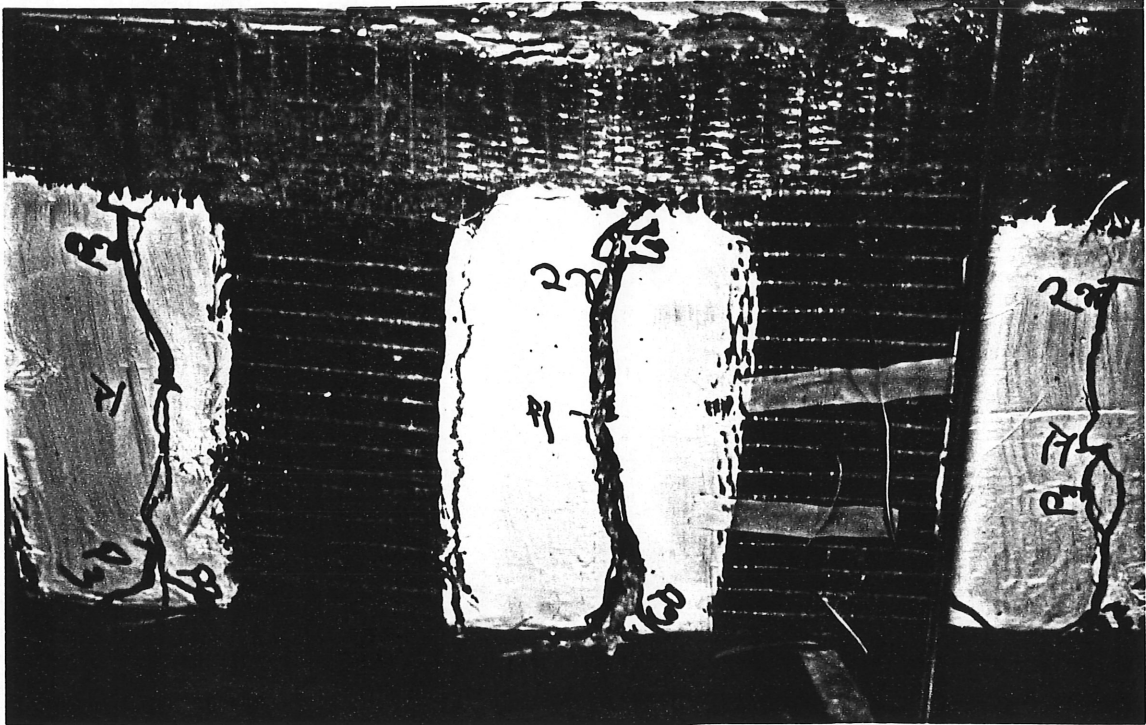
Ouverture importante d'une fissure de flexion suite à la rupture de la plaque de renforcement
